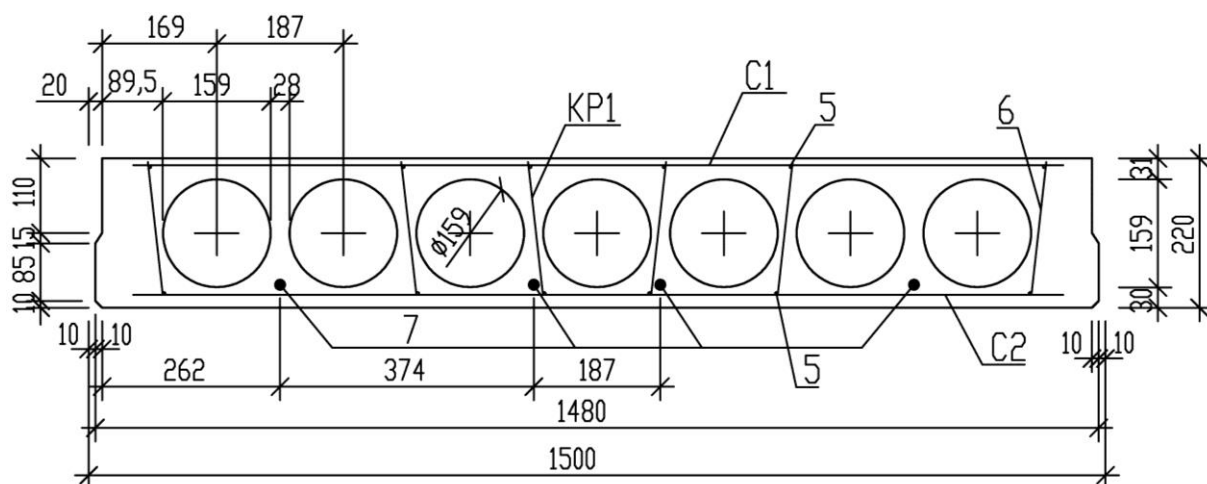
Армирование многопустотной плиты перекрытия
